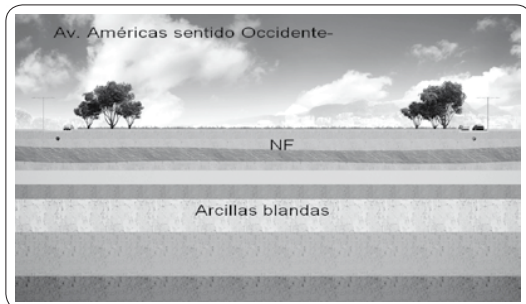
(Posible estado Futuro). Alternativa de solución para la intersección avenida Américas con Carrera 36 - Centro Nariño
